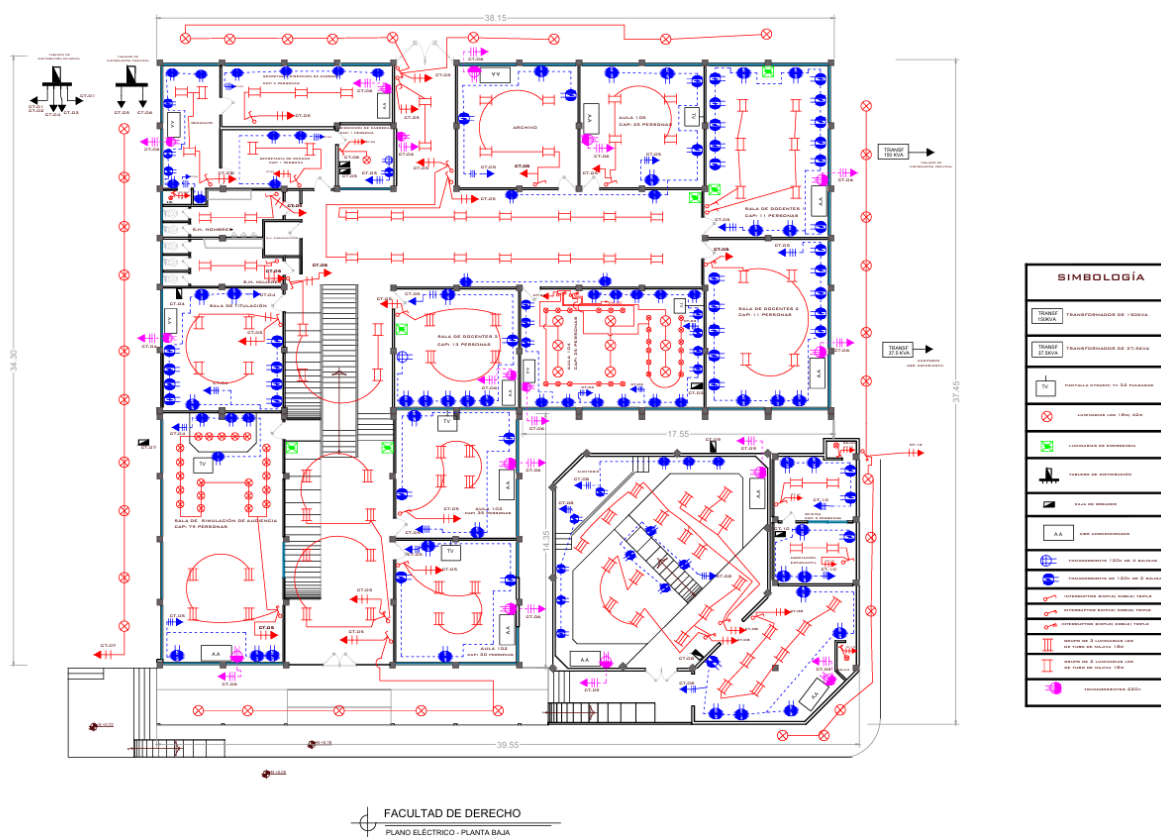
Plano eléctrico de la primera planta de la facultad de derecho; Fuente (elaboración propia)
